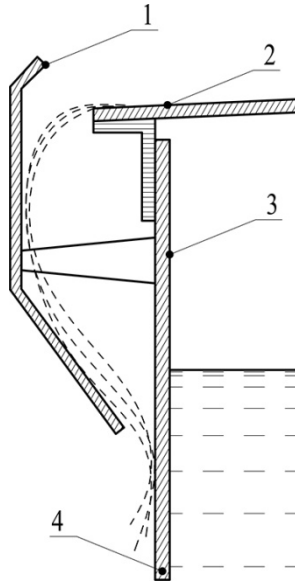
Направляючий пояс для стоку води на корпус резервуару:
